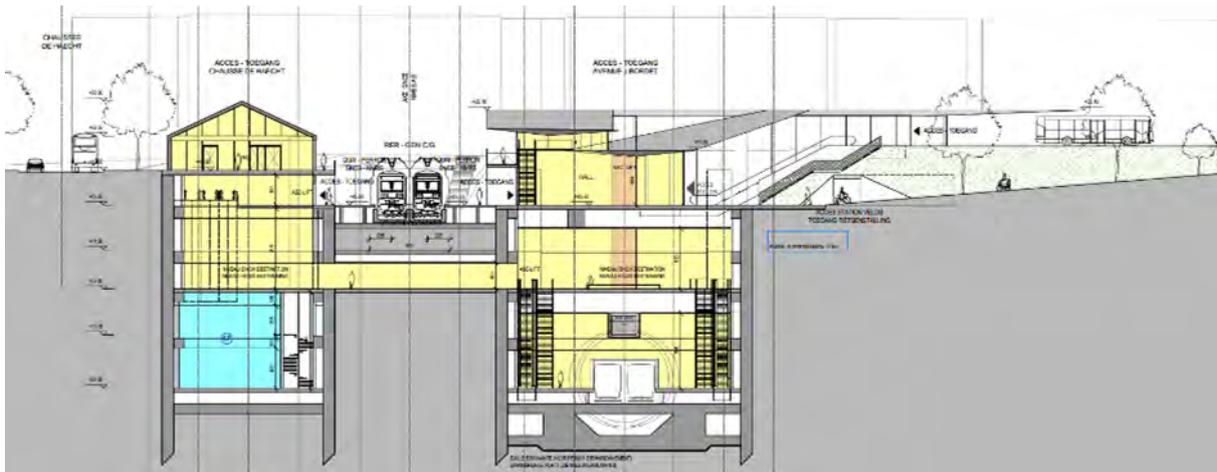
Coupe transversale de la station Bordet (BMN, 2018)
